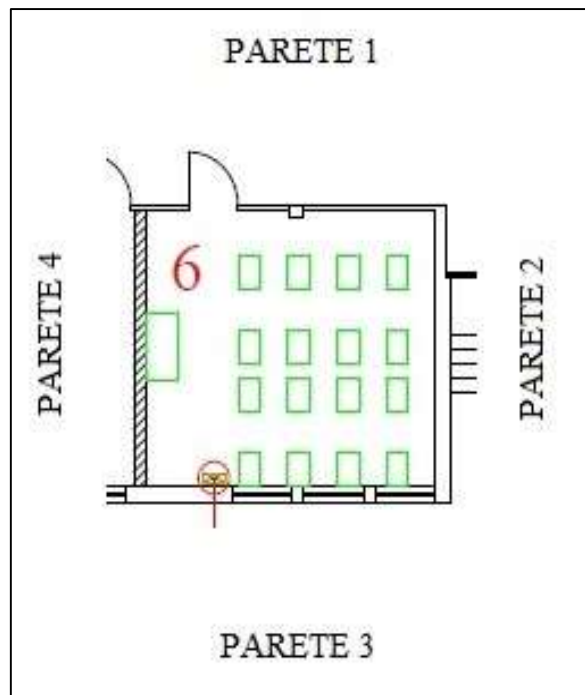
Planimetria dell'Aula 6 (4ª) oggetto di misurazioni
